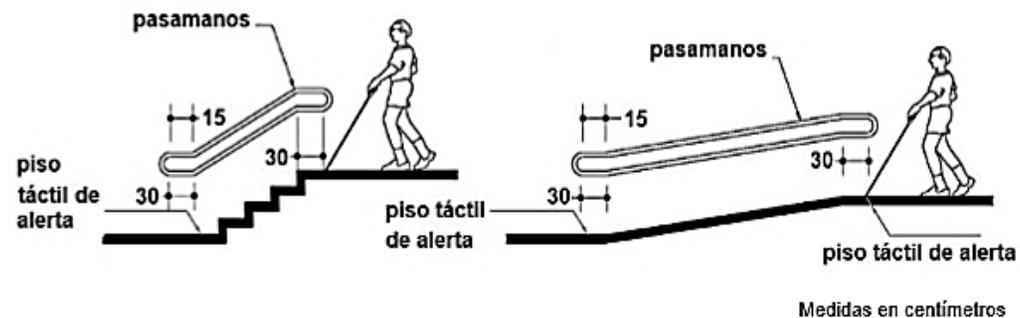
a) Vista en elevación lateral de una escalera y una rampa con respectivas alturas de los pasamanos empotrados a la pared
